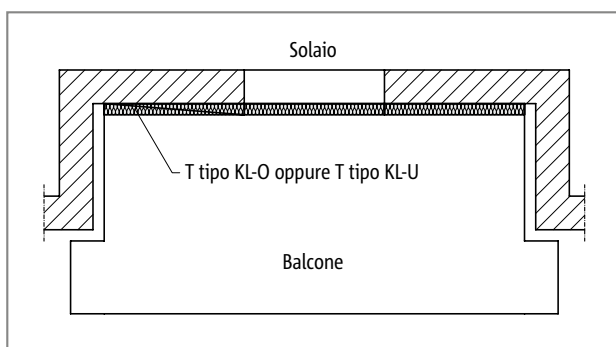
Schöck Isokorb® T tipo KL-O/KL-U: balcone con elementi rientranti nella facciata
